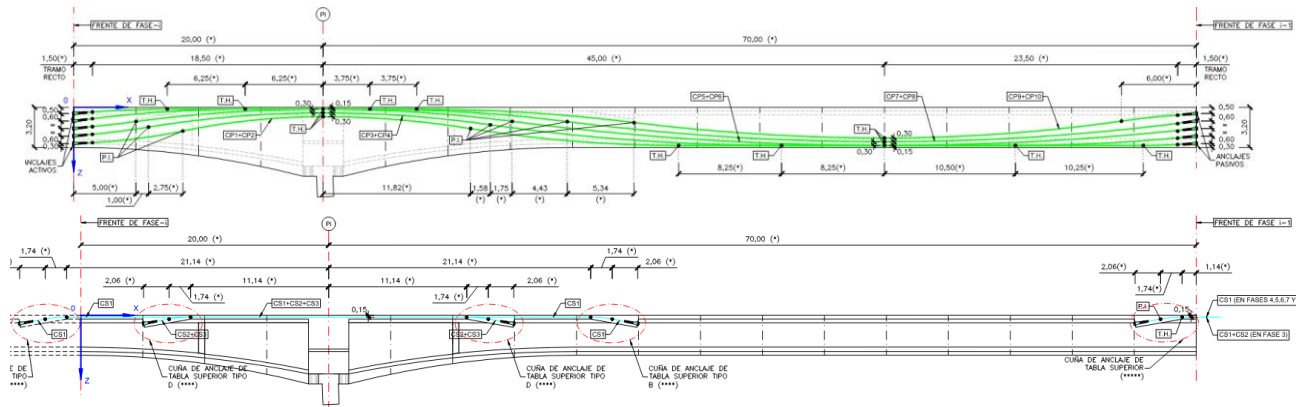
Configuración en alzado del pretensado interior de uno de los vanos tipo
